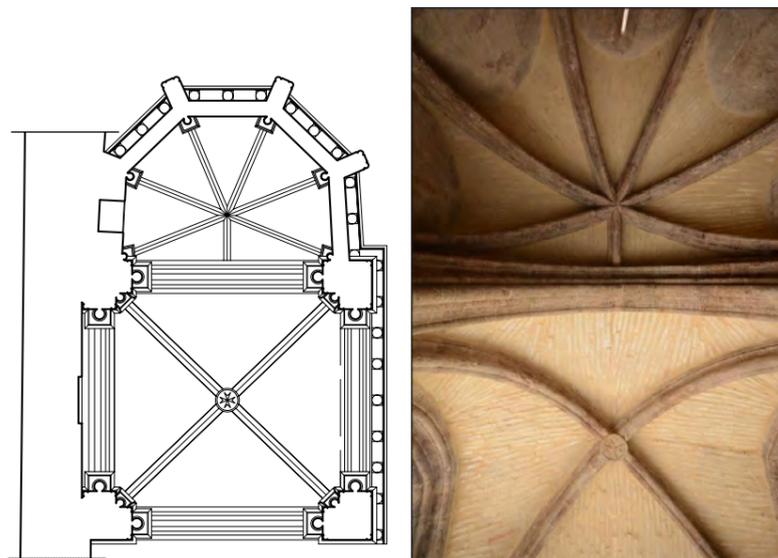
y Fig. 165. Plano de planta de la capilla del rey Jaume I elaborado por Jorge García Valldecabres (2010). Vista cenital de la capilla del rey Jaume I. (Fuente: www.flickr.com)
